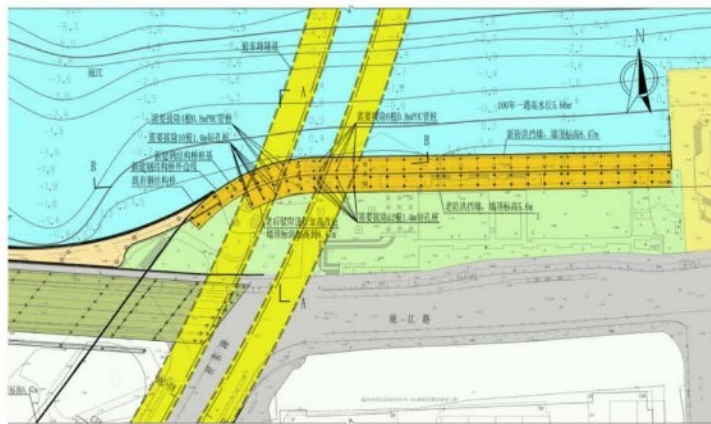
南岸防洪堤与隧道关系平面图
